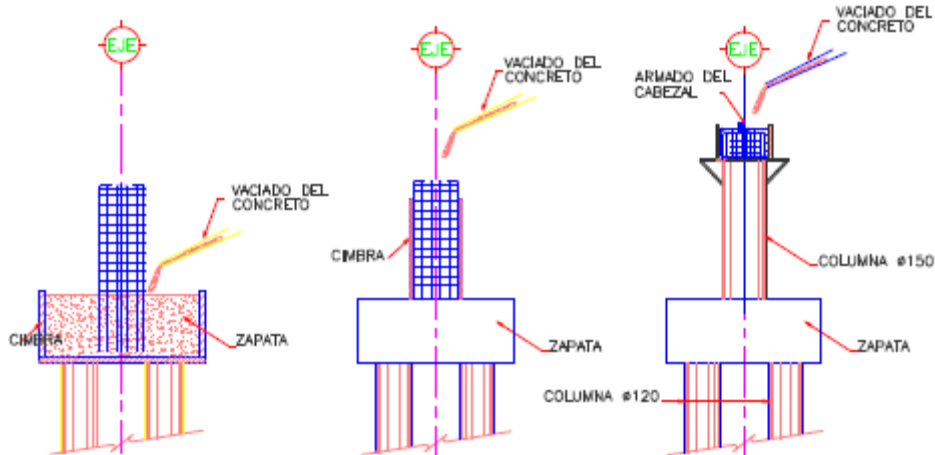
Procedimiento para el armado y colado de las pilas de cimentación.
